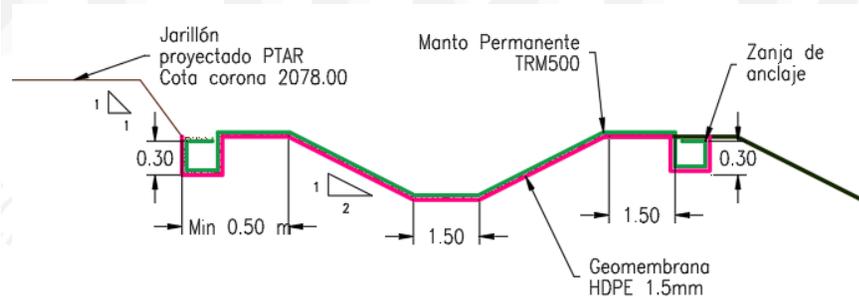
Tipo de la Obra:				Canal Trapezoidal 2
